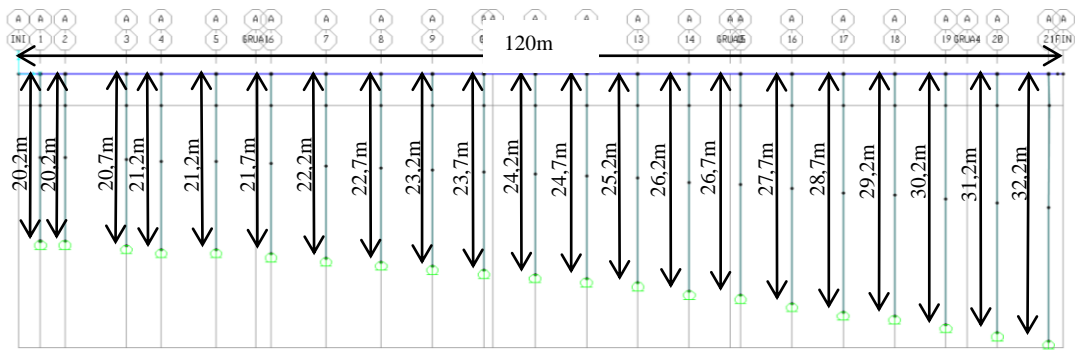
Vista en elevación del plano A de geometría, paralelo a plano X-Vertical'.
